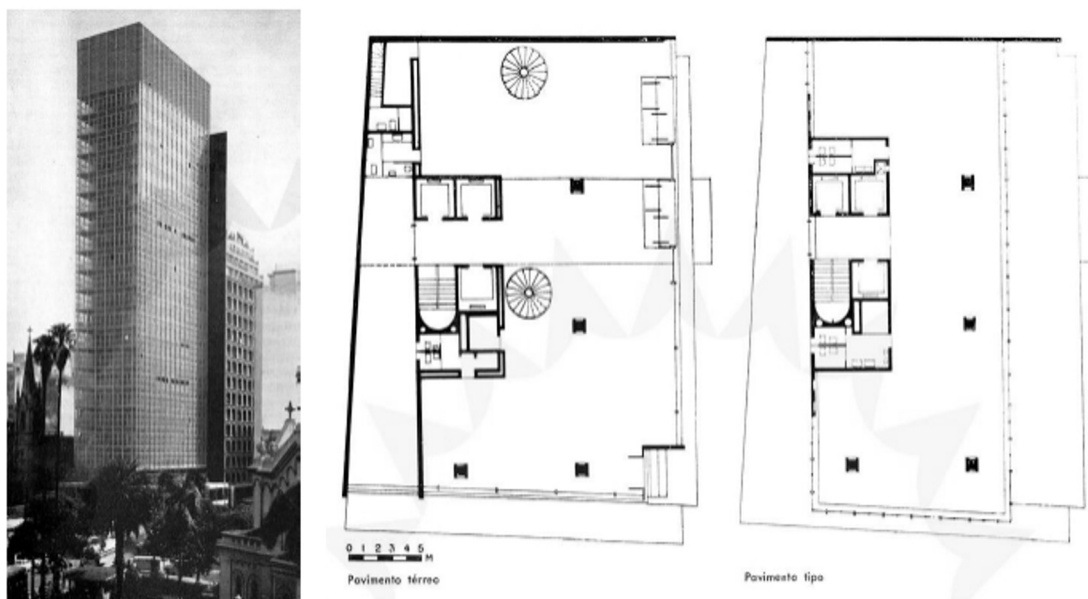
Vista do edifício Wilton Paes de Almeida e plantas dos pavimentos térreo e tipo (fonte: Revista Acrópole, 1965)
